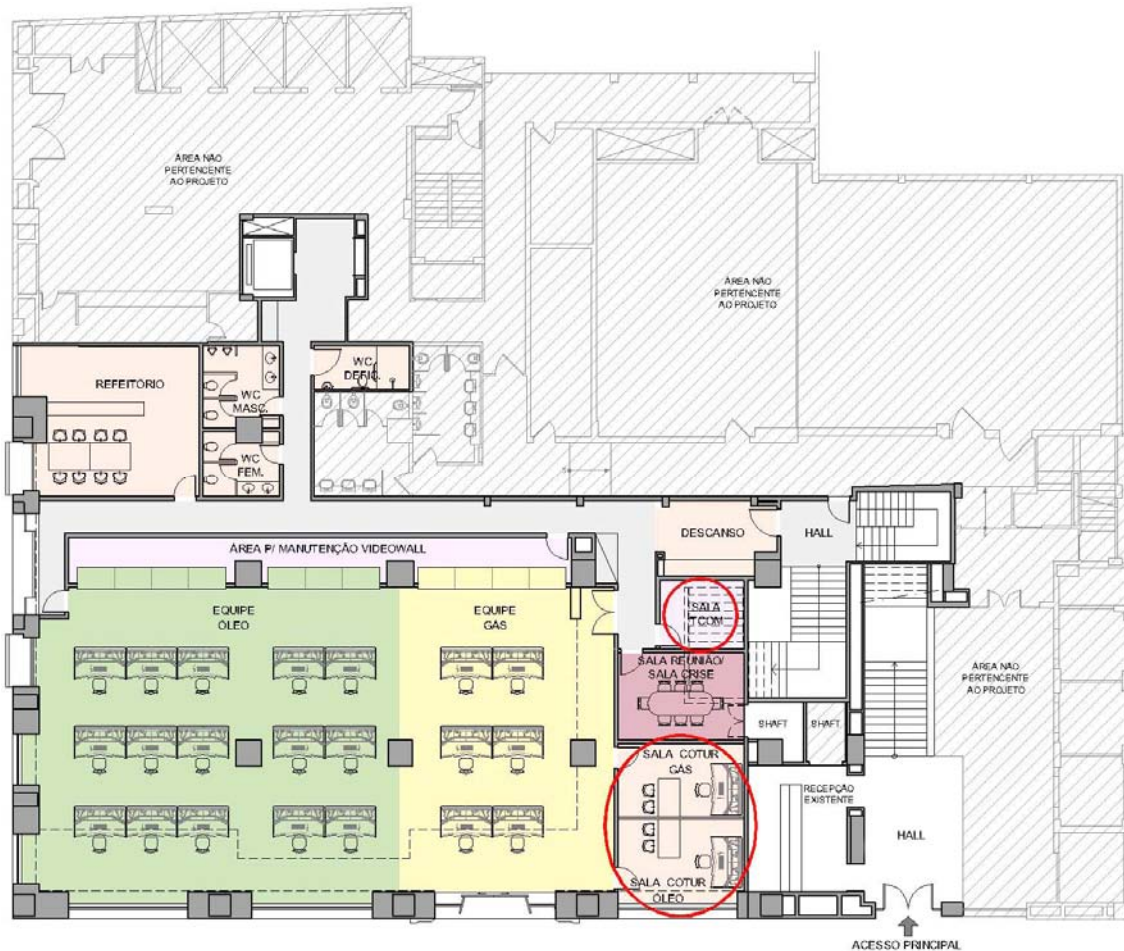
Planta baixa pavimento térreo: alterações do layout (vinte de junho)
